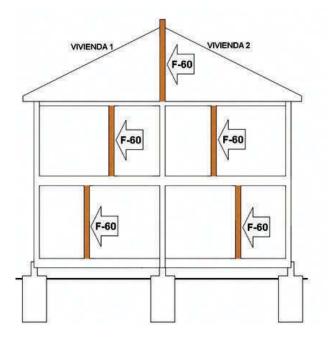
37: Corte esquemático de utilización del tabique cortafuego Owens Corning STD.
